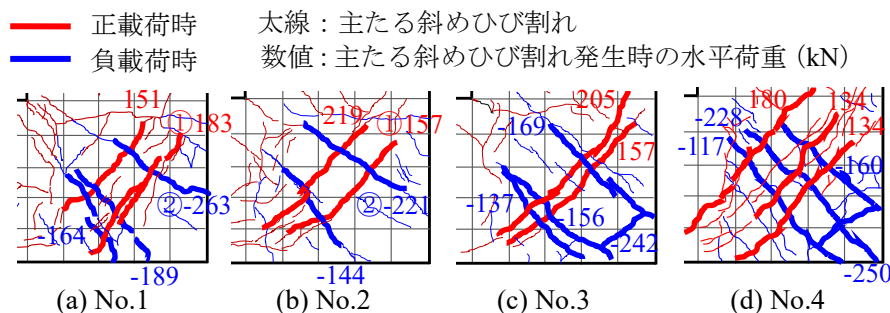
ひび割れ性状（コンクリートがはく落する直前）
